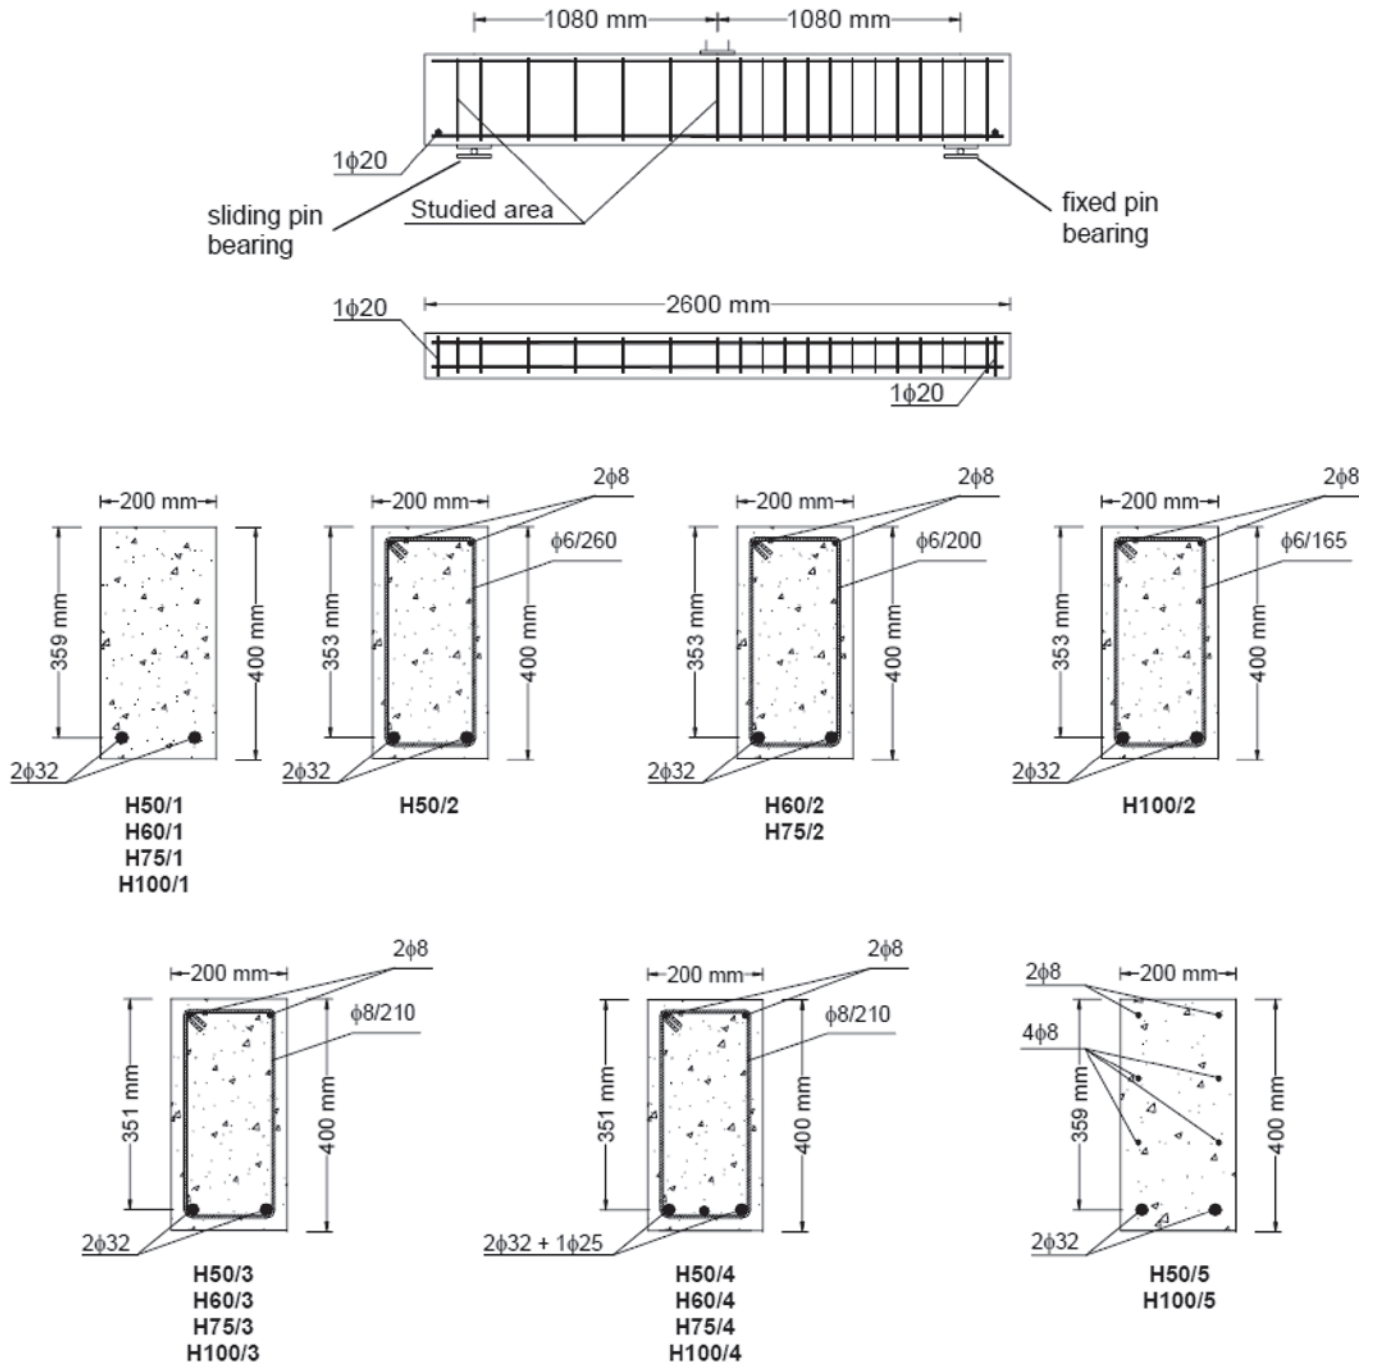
Esquema de ensaio e seções transversais das vigas ensaiadas. (Cladera [2])
